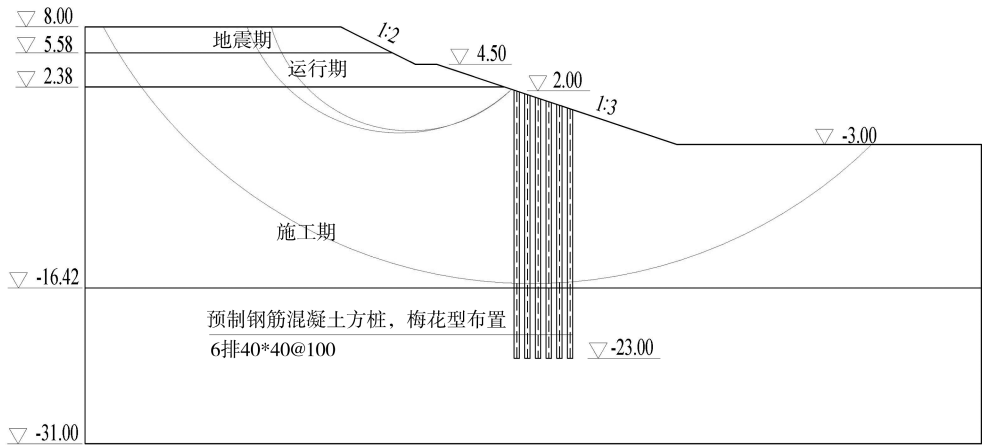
河道边坡稳定计算结果(预制钢筋混凝土方桩,单位:m)
